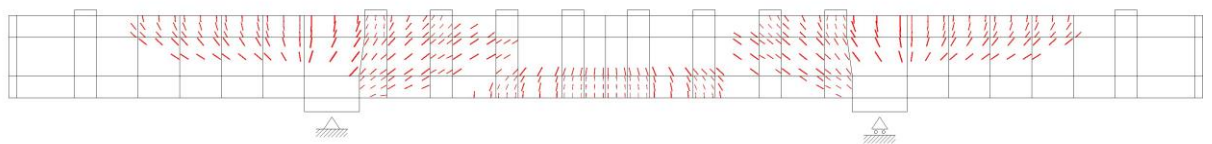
破壊時の変形及びひび割れ状態 (Case No. 16)
